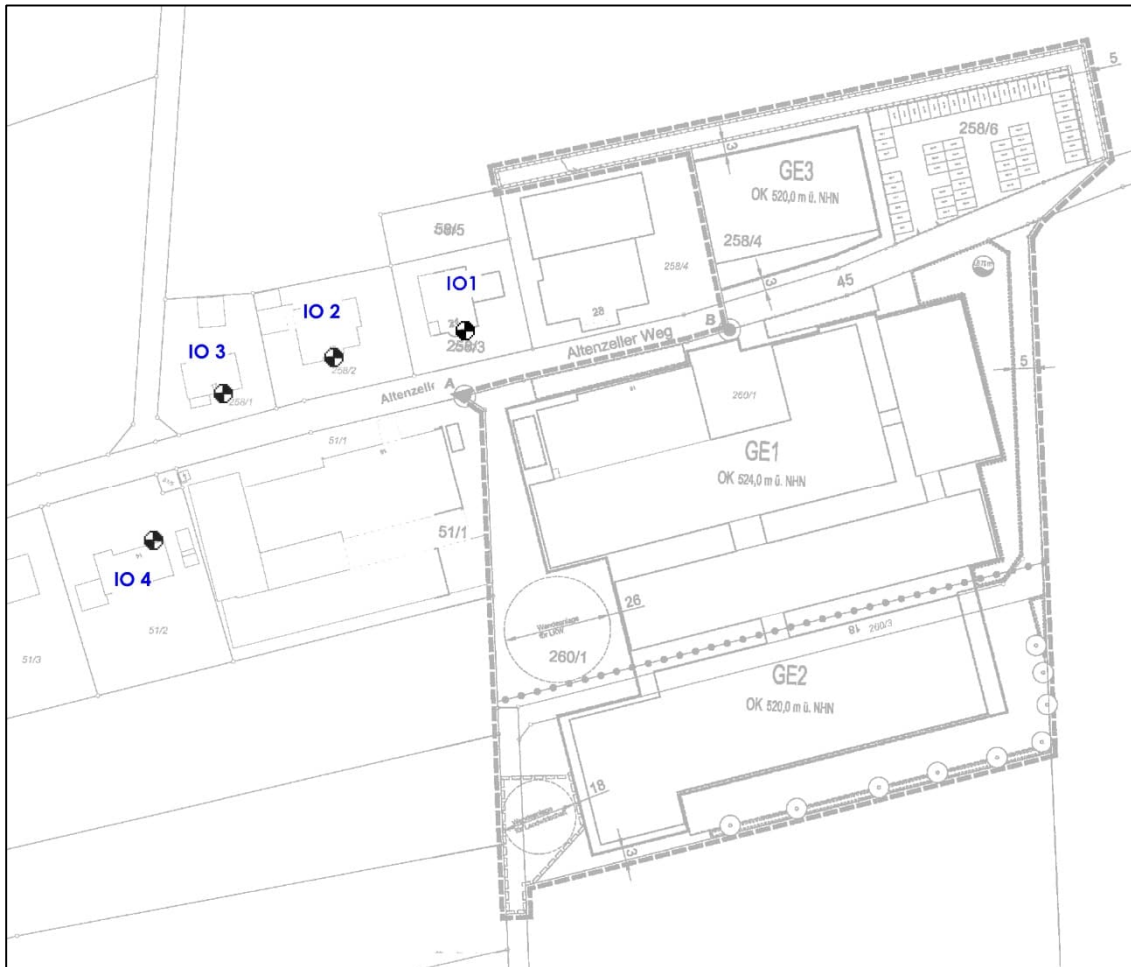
Lageplan mit Darstellung der maßgeblichen Immissionsorte
